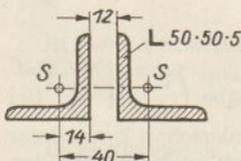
Fachwerkstab aus 2 L-Eisen.
